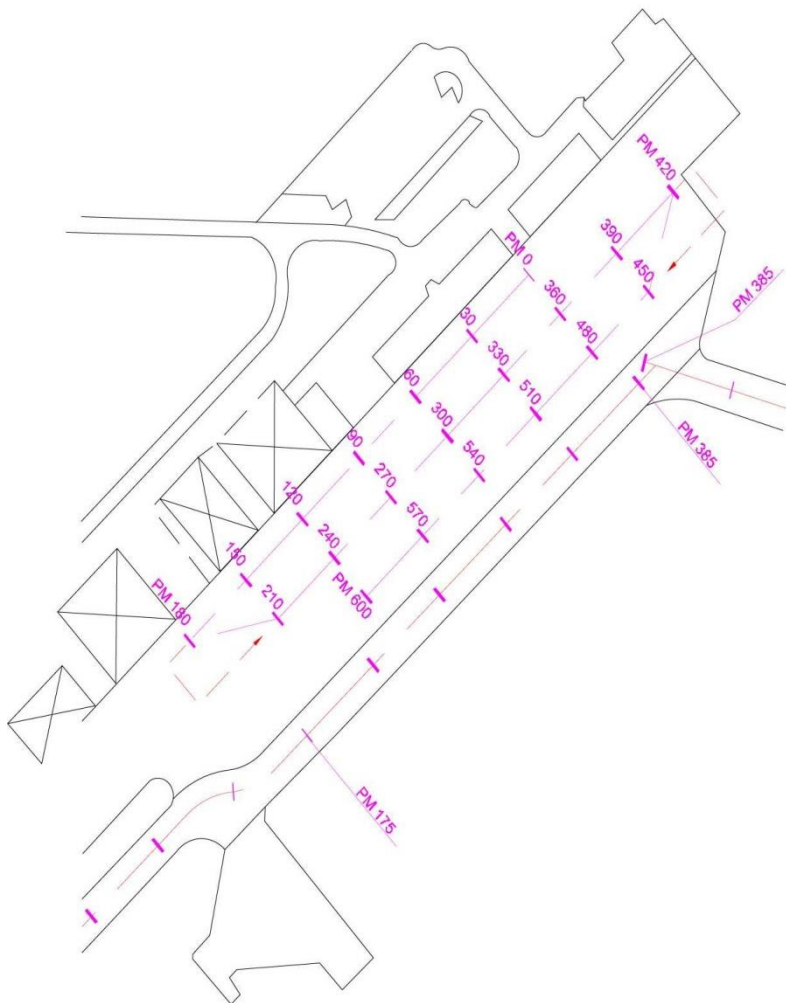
Exemple d'un découpage d'une aire de stationnement sur chaussée souple (STBA, 2003)
